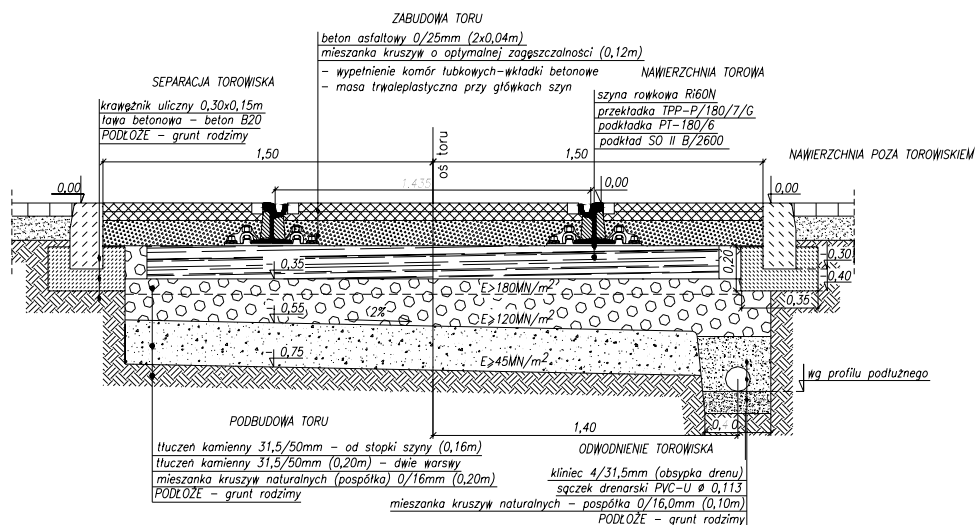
Przekroje konstrukcyjne modernizowanego torowiska tramwajowego
